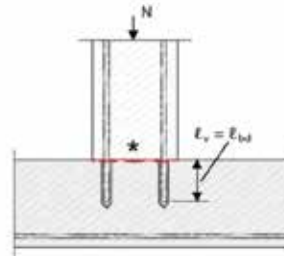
Juntas solapadas en cimentación de columna o muro donde la varilla estén tensadas
